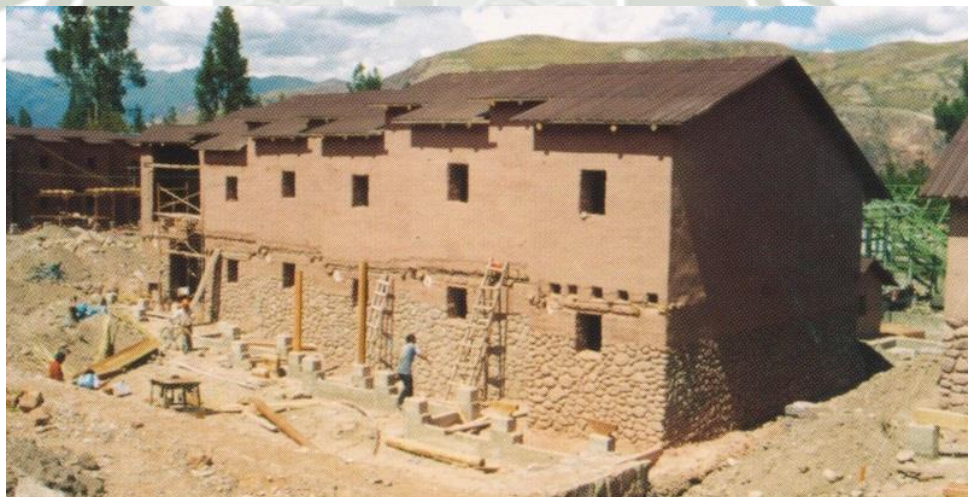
Proceso constructivo con muros de piedra y adobe encima.
